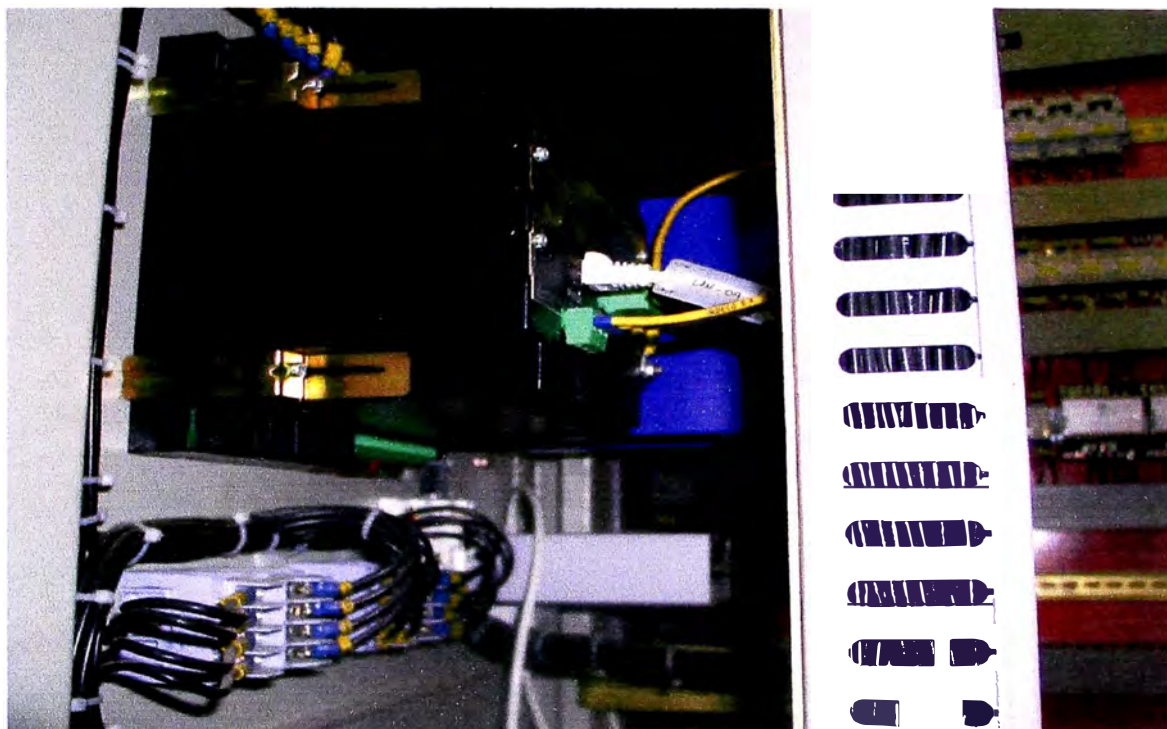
Conexionado de red LAN en medidor ION 7600
